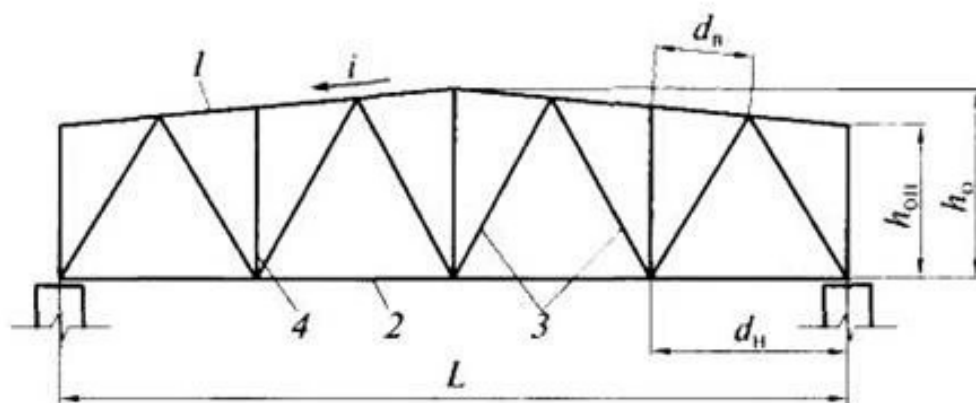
элементы фермы: 1 — верхний пояс; 2 — нижний пояс; 3- раскосы; 4 — стойка
